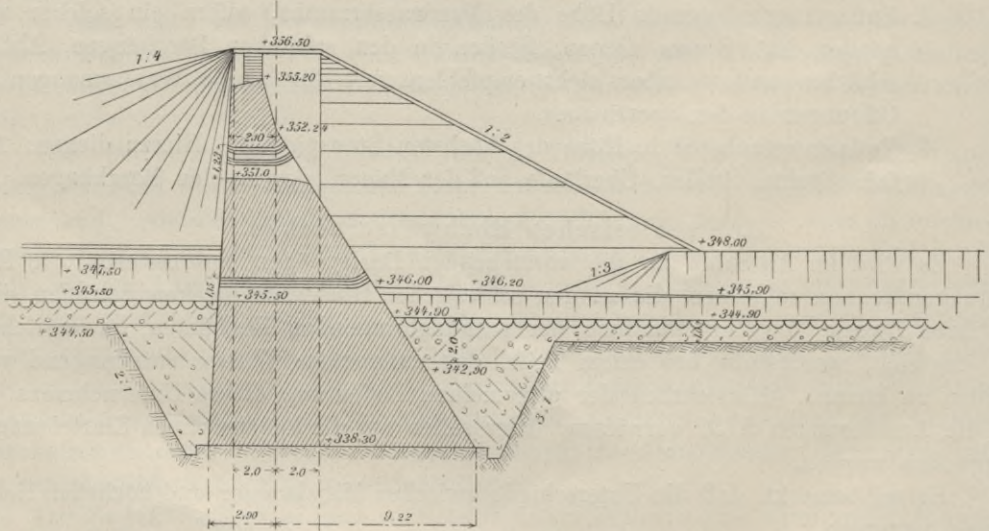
u. 250. Aufriß und Querschnitt des gemauerten Überlaufs im Staudamm des Stauweihers im Zacken.
